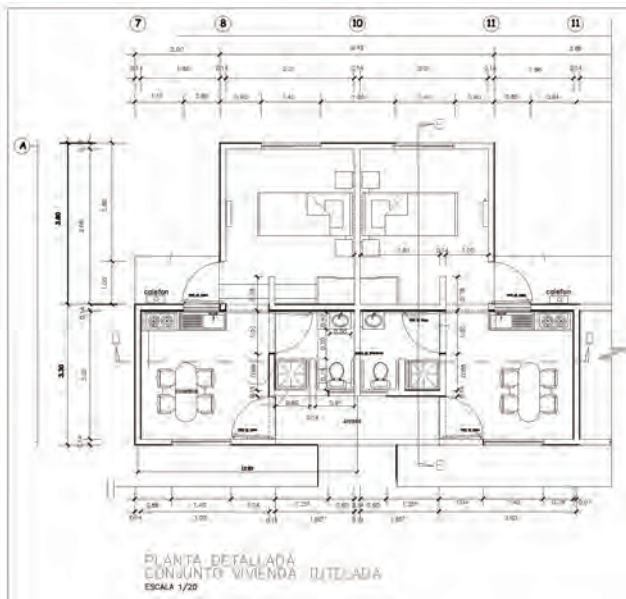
Planta detalle viviendas Tuteladas San Ramón. Fuente: Arquitecto Francesca Clandestino
